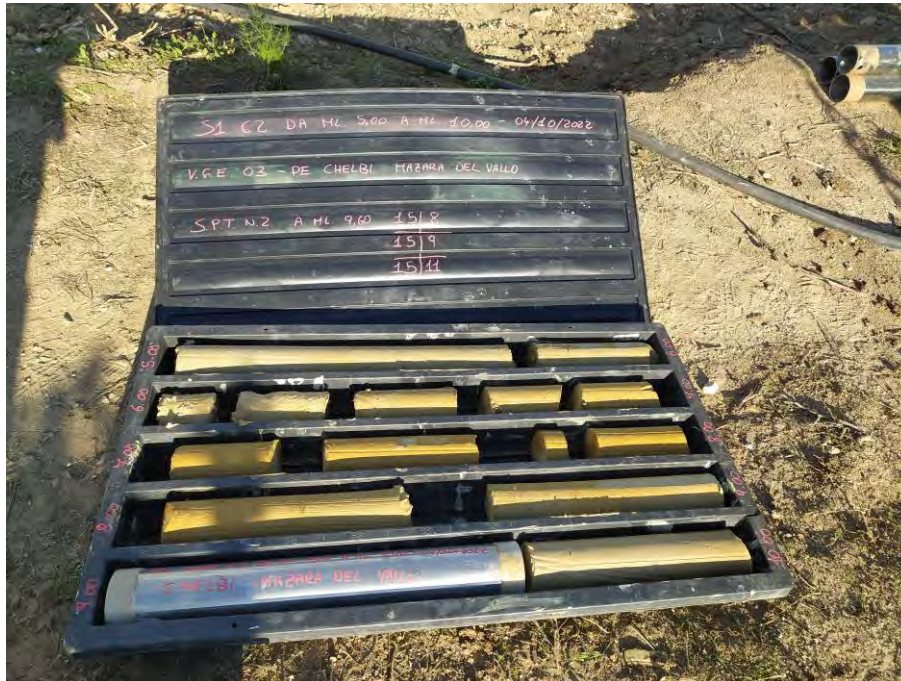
Cassetta n°2 (da 5.0 m a 10.0 m) del sondaggio S1 - CH6.
